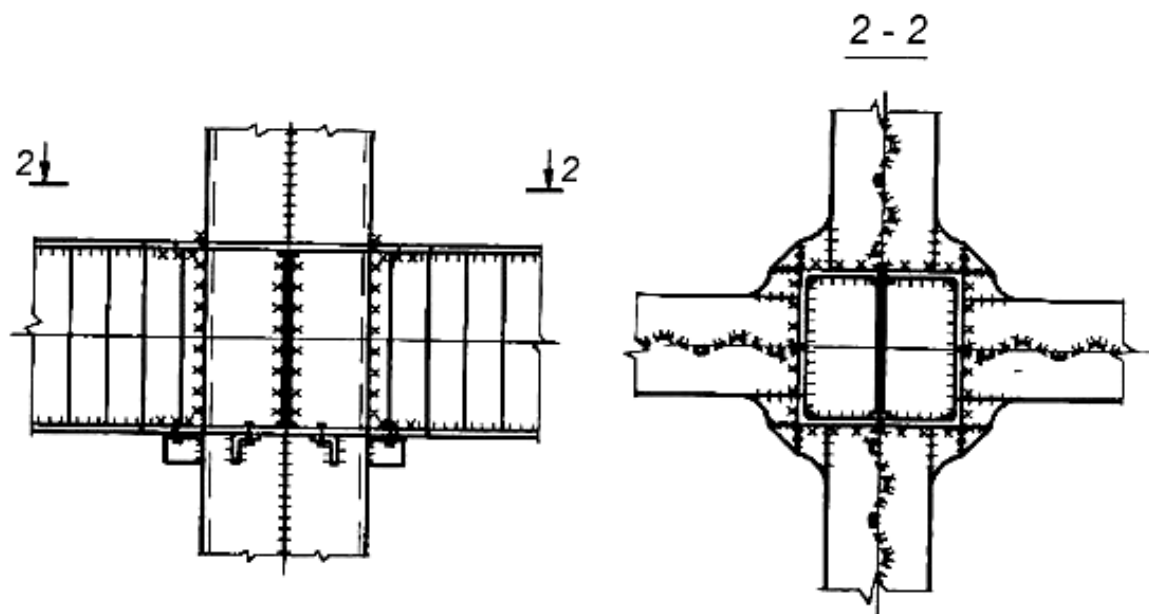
Сварной рамный узел каркаса
